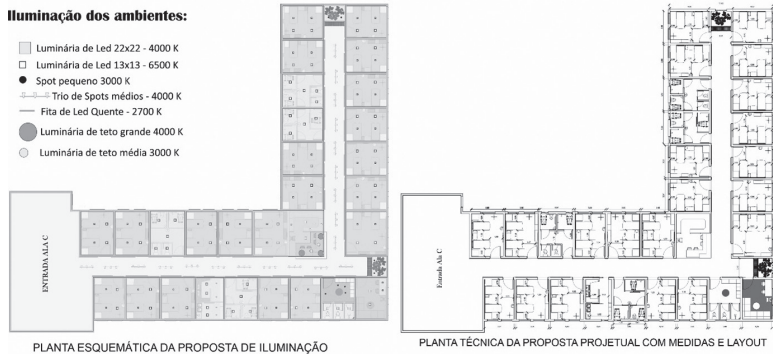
Planta Luminotécnica e planta com medidas e layouts do projeto de reforma
